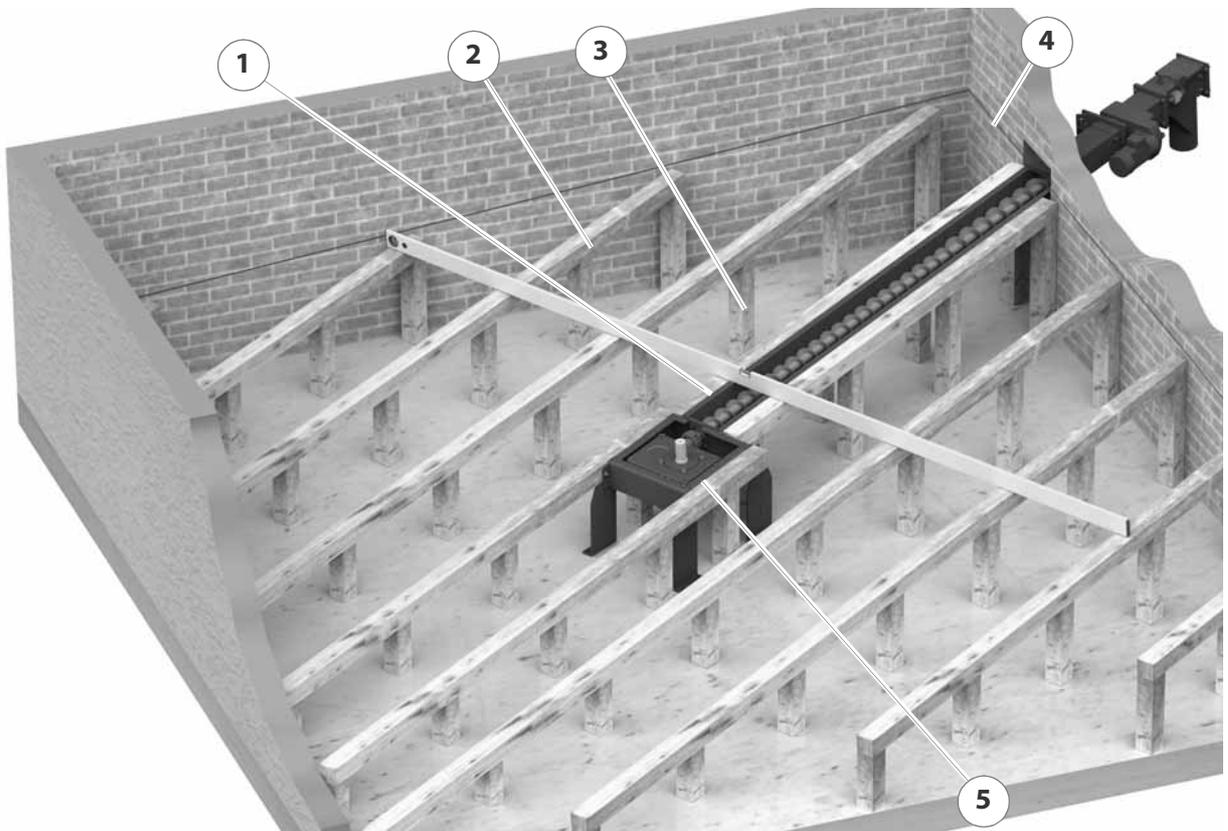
/14 — Construction inférieure (bac fermé pas à 90° par rapport au mur)
